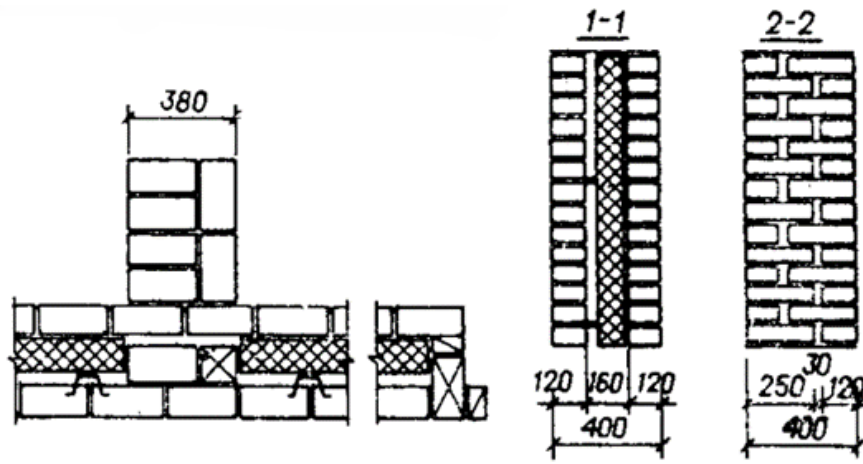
Зовнішня стіна з утеплювачем та без утеплювача
